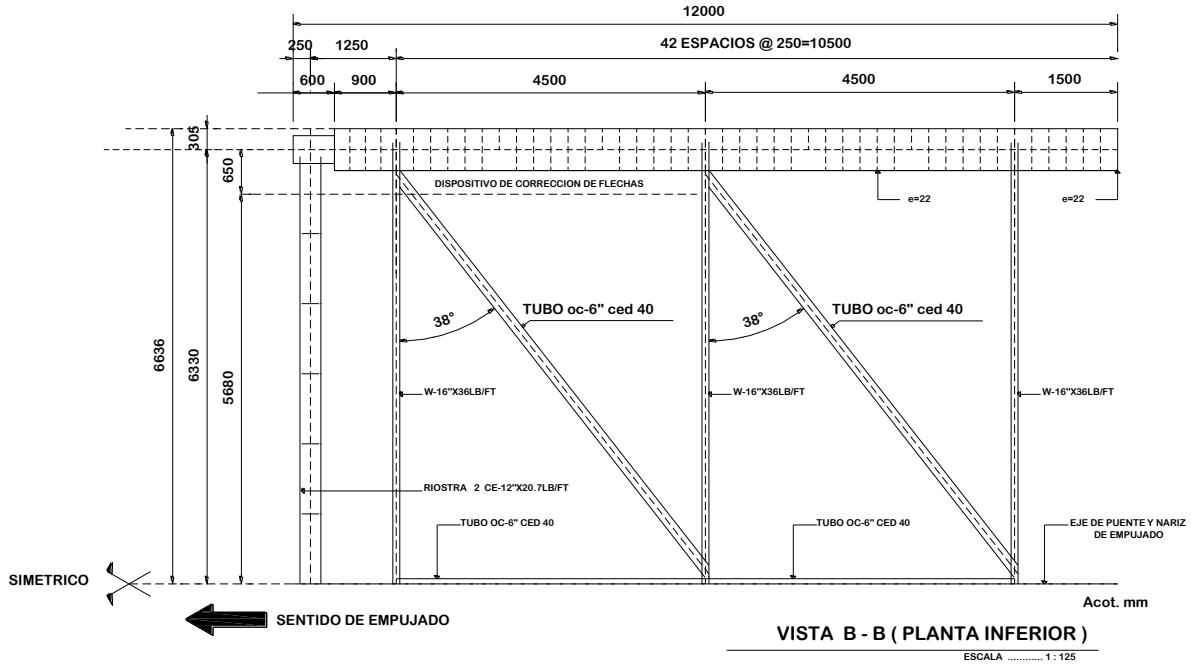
Nariz de lanzamiento, vista planta inferior
